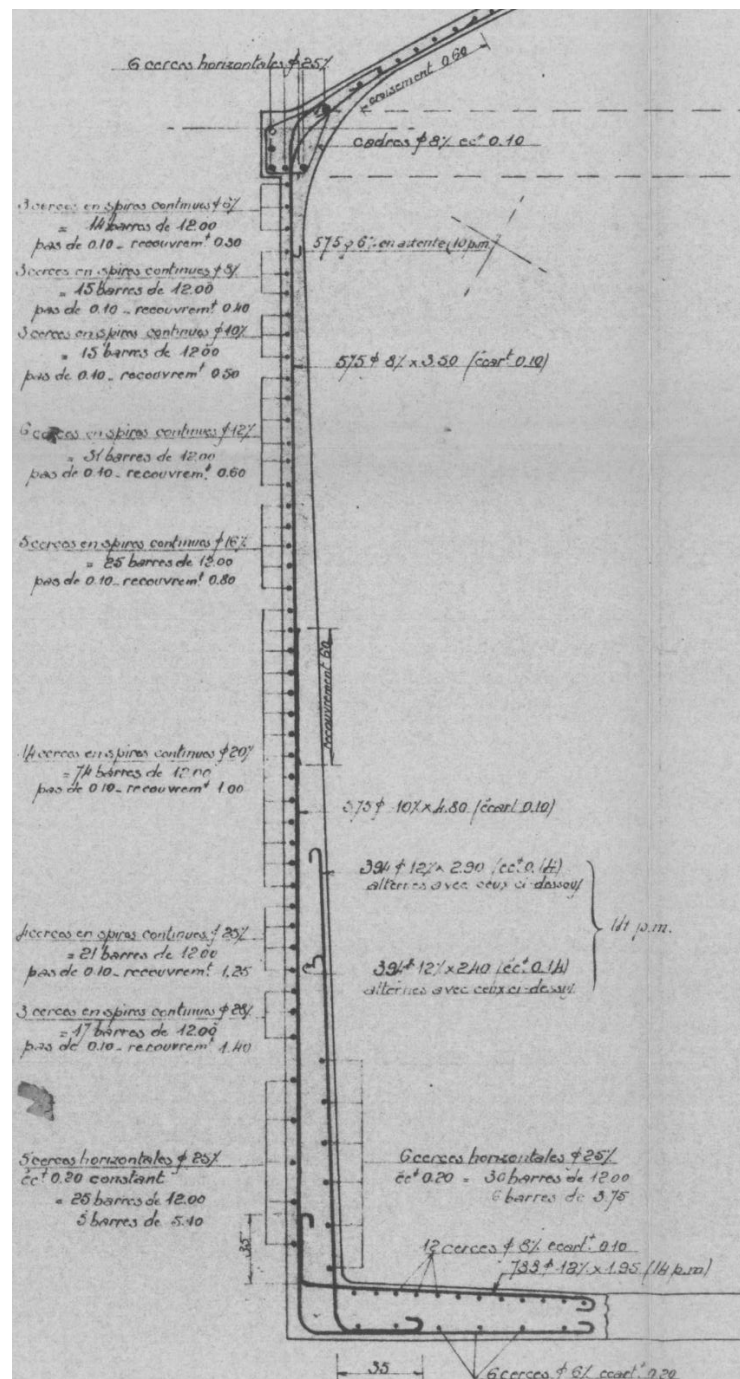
Extrait du plan d'armatures du réservoir en béton armé de 1400 m³ demi-coupe à l'échelle 1/20^{ème}
